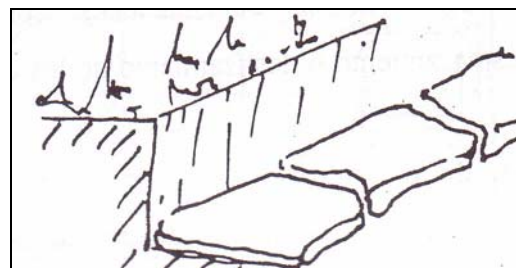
Enlosado del fondo de la cimentación según Palladio.
